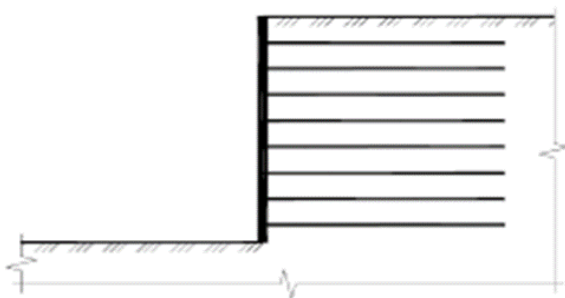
Загальна схема горизонтального армування при будівництві котлованів
